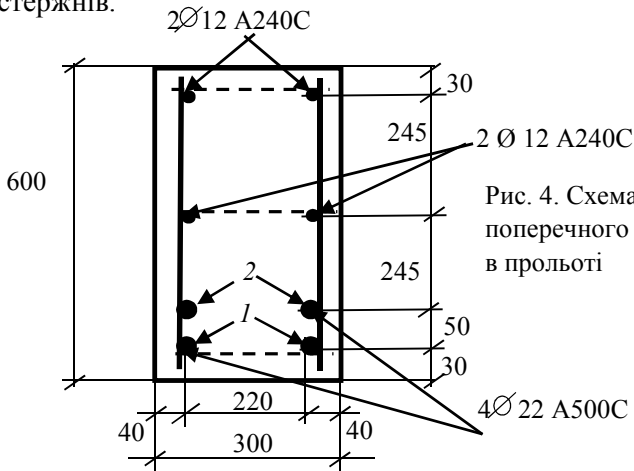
Схема армування поперечного перерізу балки в прольоті
